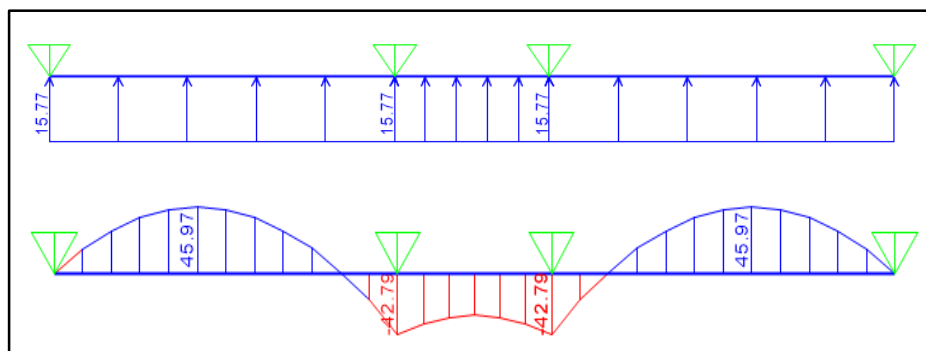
DMF de la viga - Zapata reticular con viga de cimentación - Sistema apertado
